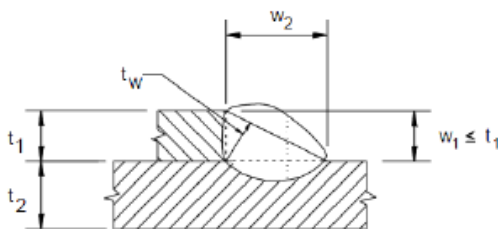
A Soldaduras de filete - Unión solapada
